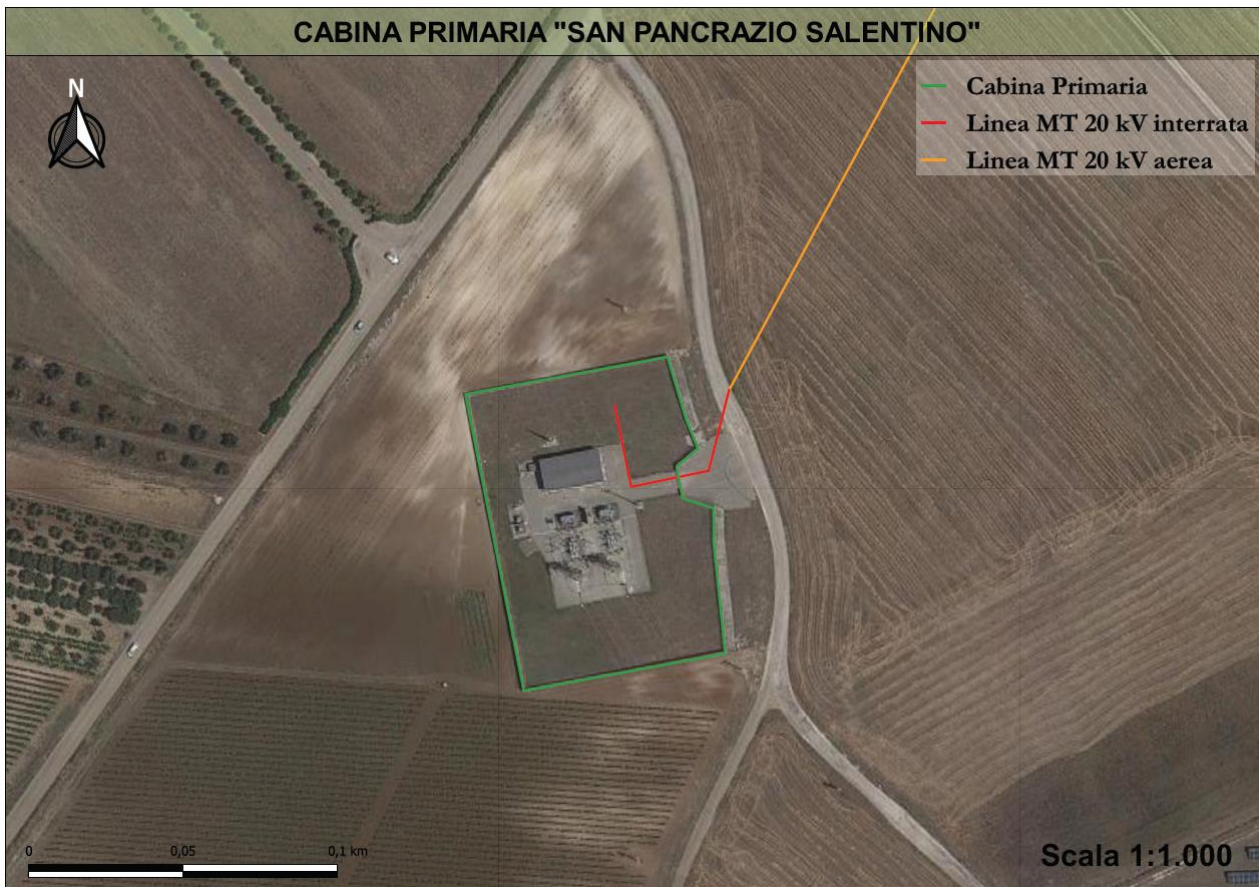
Planimetria Cabina Primaria "San Pancrazio Salentino"
